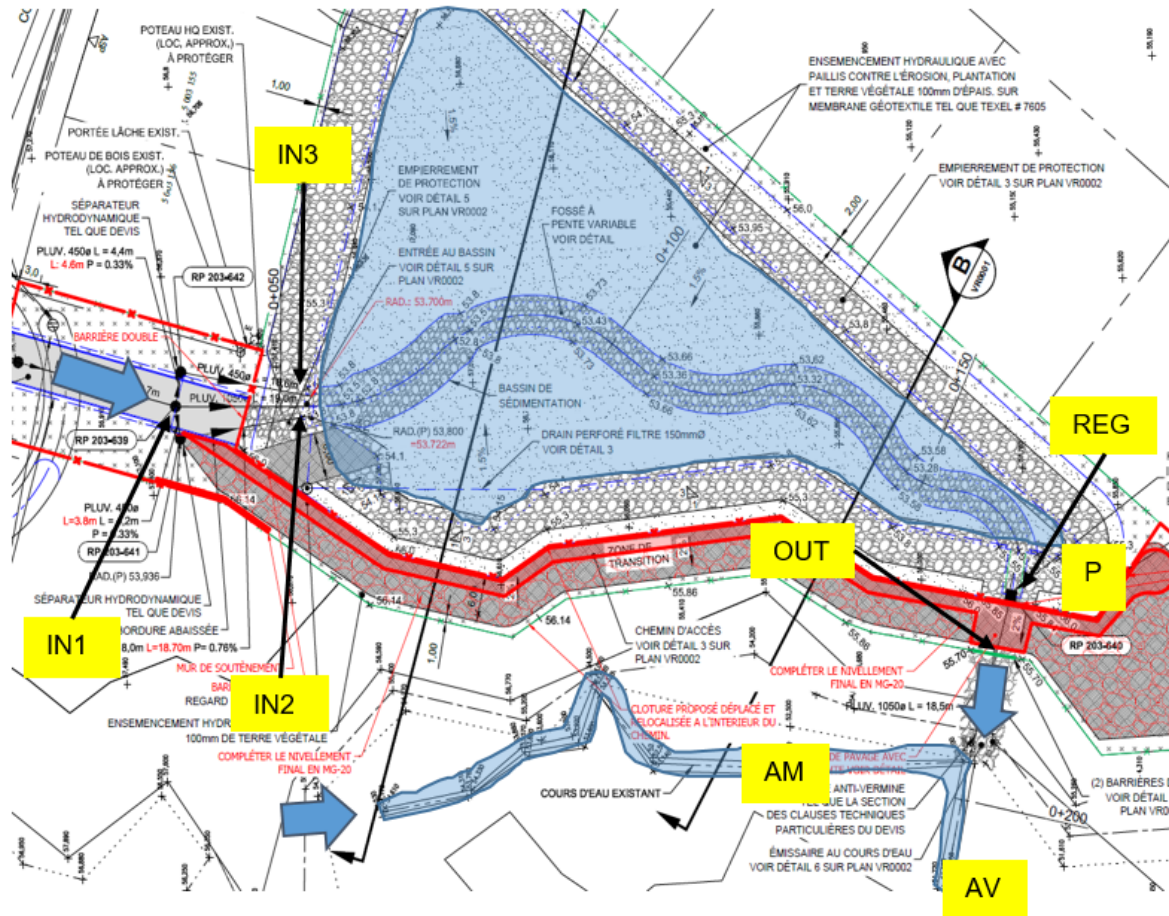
Plan d'échantillonnage et d'instrumentation au site TR (adapté de Dessau, 2016) .
